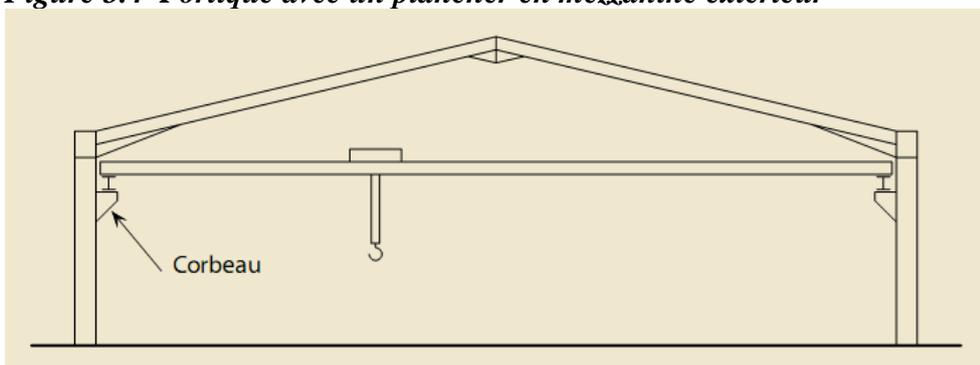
Portique avec un corbeau sur les poteaux
